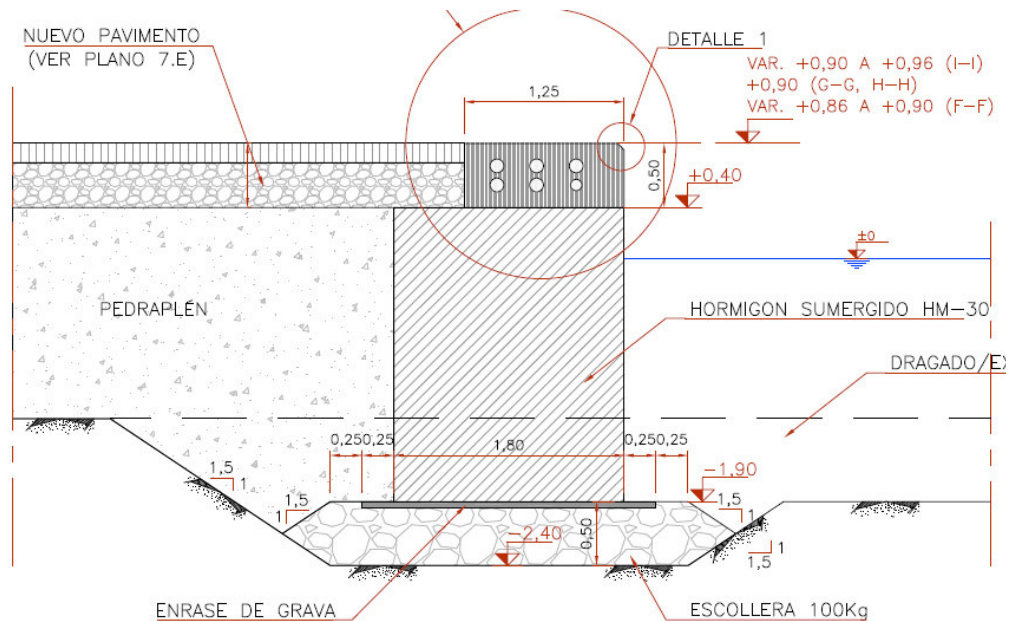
Sección Muelle Norte propuesta en Proyecto Constructivo
